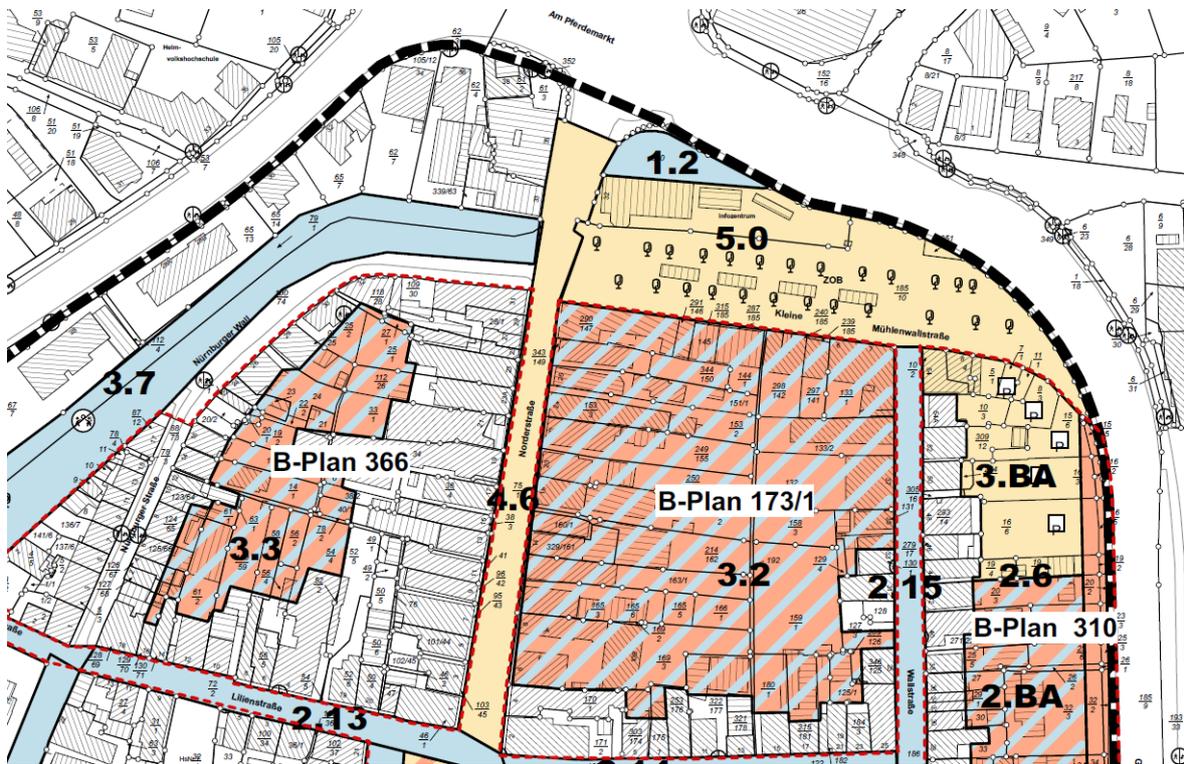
Durchführungsplan im Bereich ‚Norderstraße und ZOB‘ (siehe Tabelle 10)
